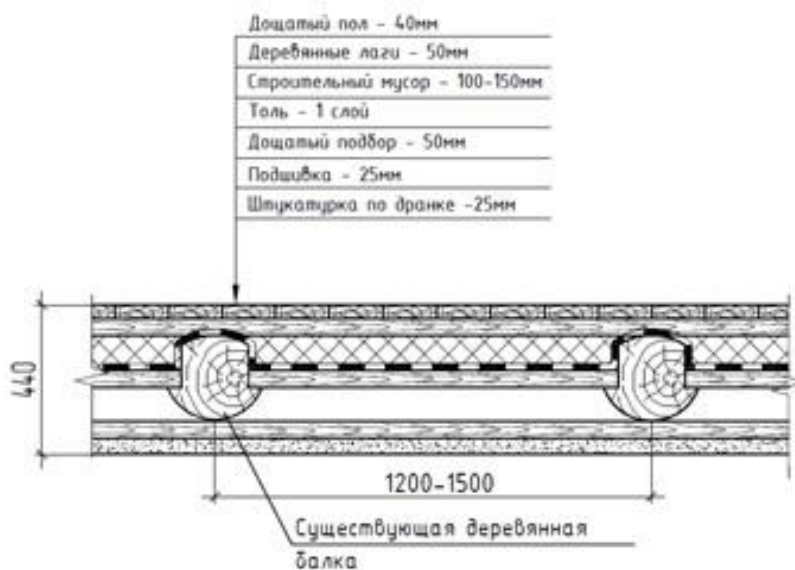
Наиболее часто встречаемая конструкция междуэтажного перекрытия по деревянным балкам в старом фонде
